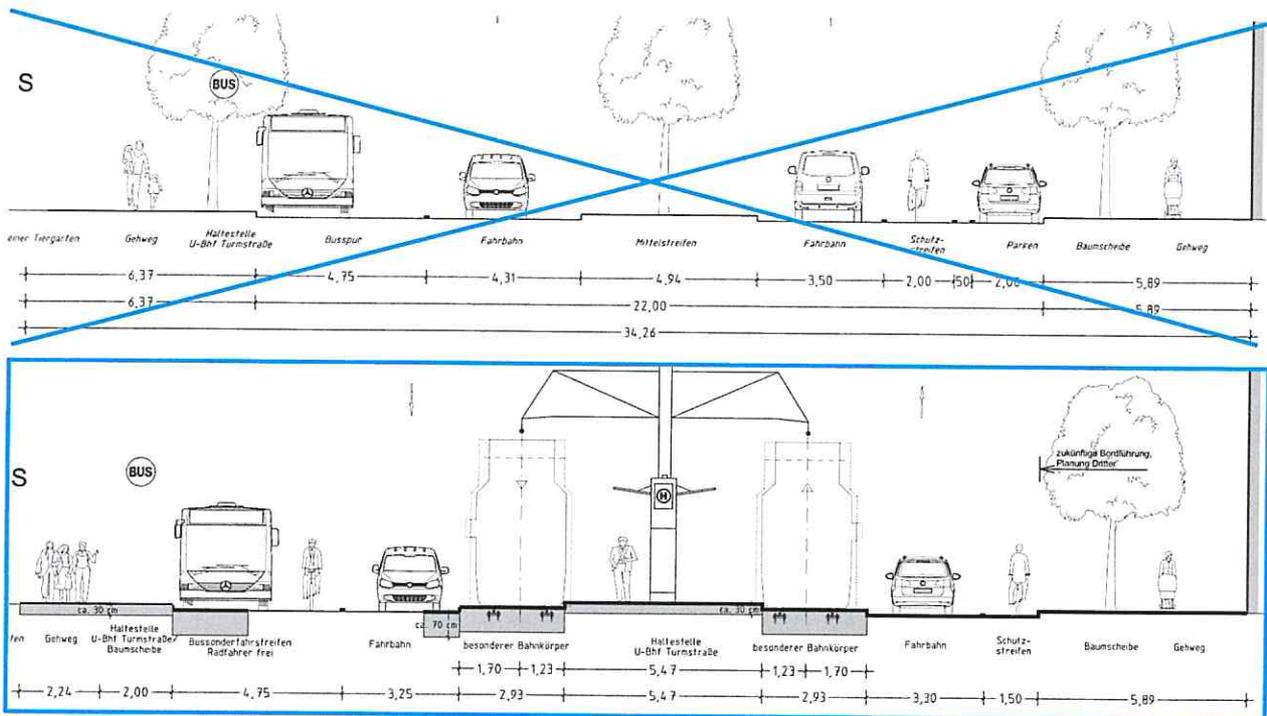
Querprofil 5.2 Turmstraße, Haltestelle U-Bahnhof Turmstraße (Blickrichtung West)
